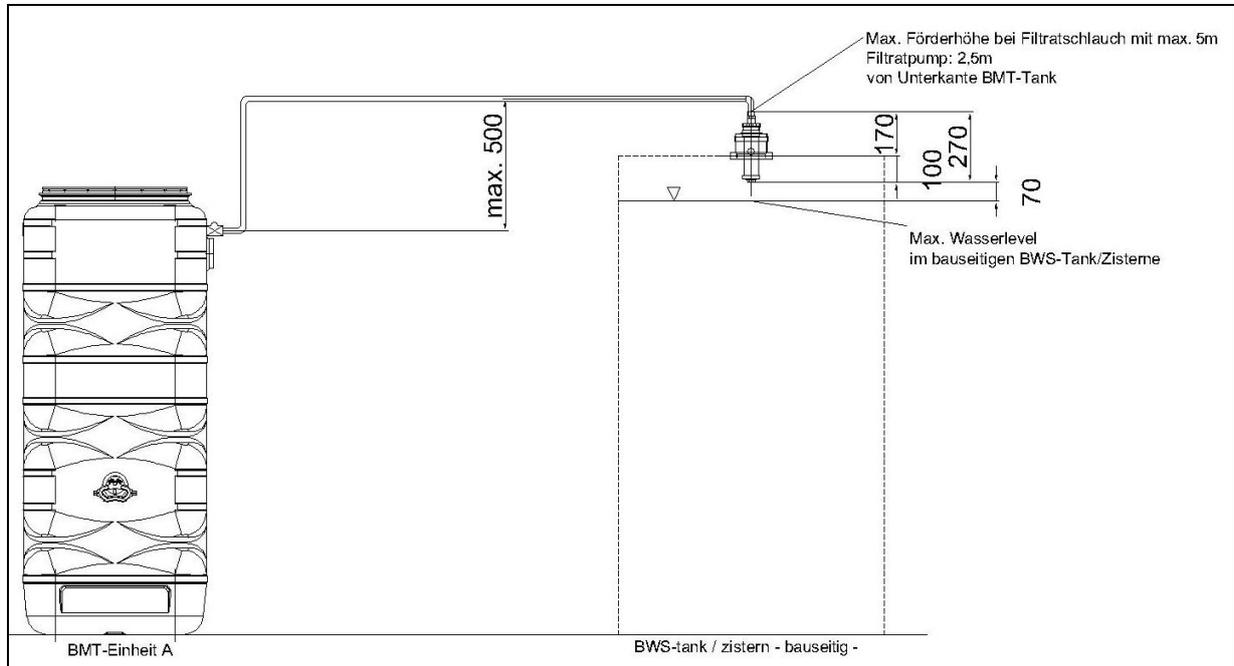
Anschluss Filtratschlauch an FÜB montiert im bauseitigem Betriebswassertank
